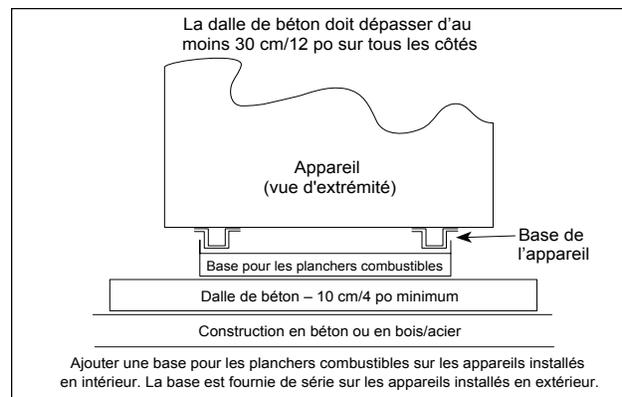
Installation caractéristique de l'appareil de chauffage sur une dalle en béton
